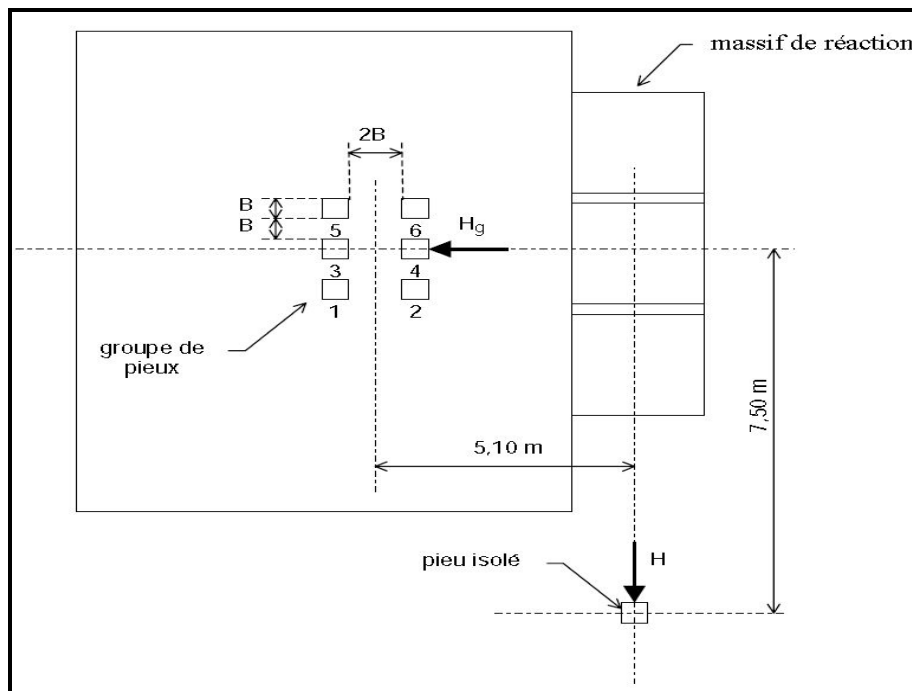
Site de Plancoët. Disposition du groupe et du pieu isolé.
